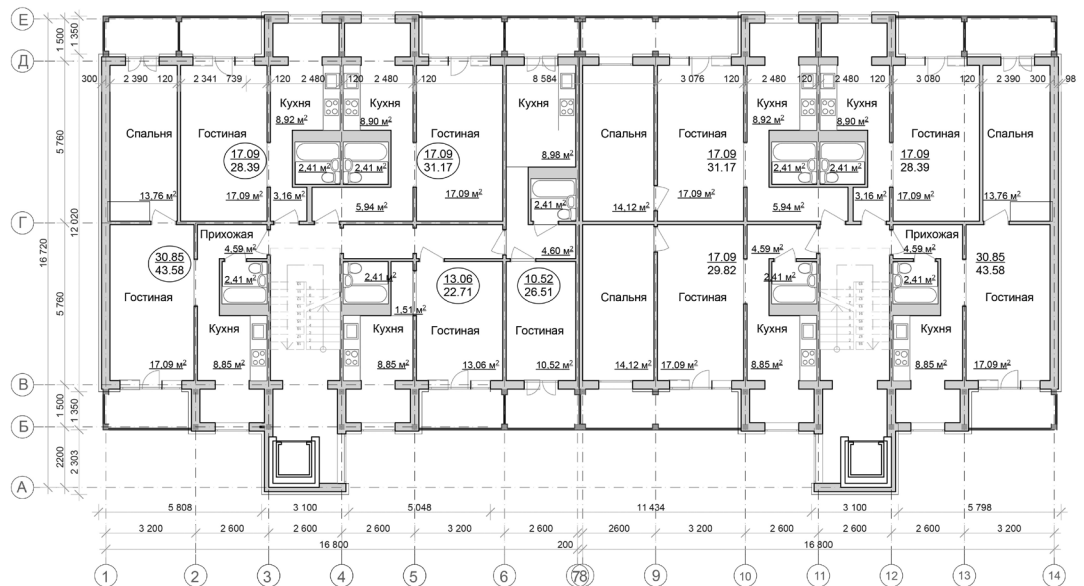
План первого и типового этажа. Реконструкция с надстройкой мансардных этажей
